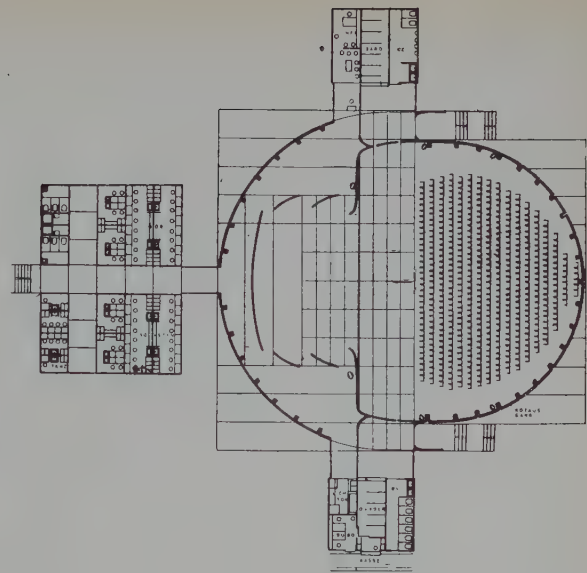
Grundriß des fertig aufgebauten Theaters 1:600
